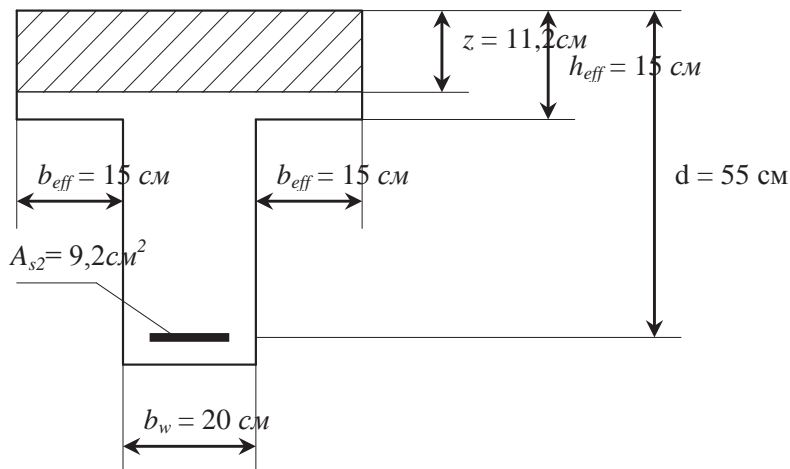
Схема поперечного перерізу елемента при положенні нейтральної лінії в поліці
